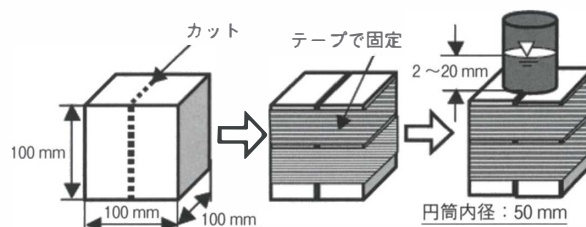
ひび割れを模擬した透水試験の概要⁵⁾
